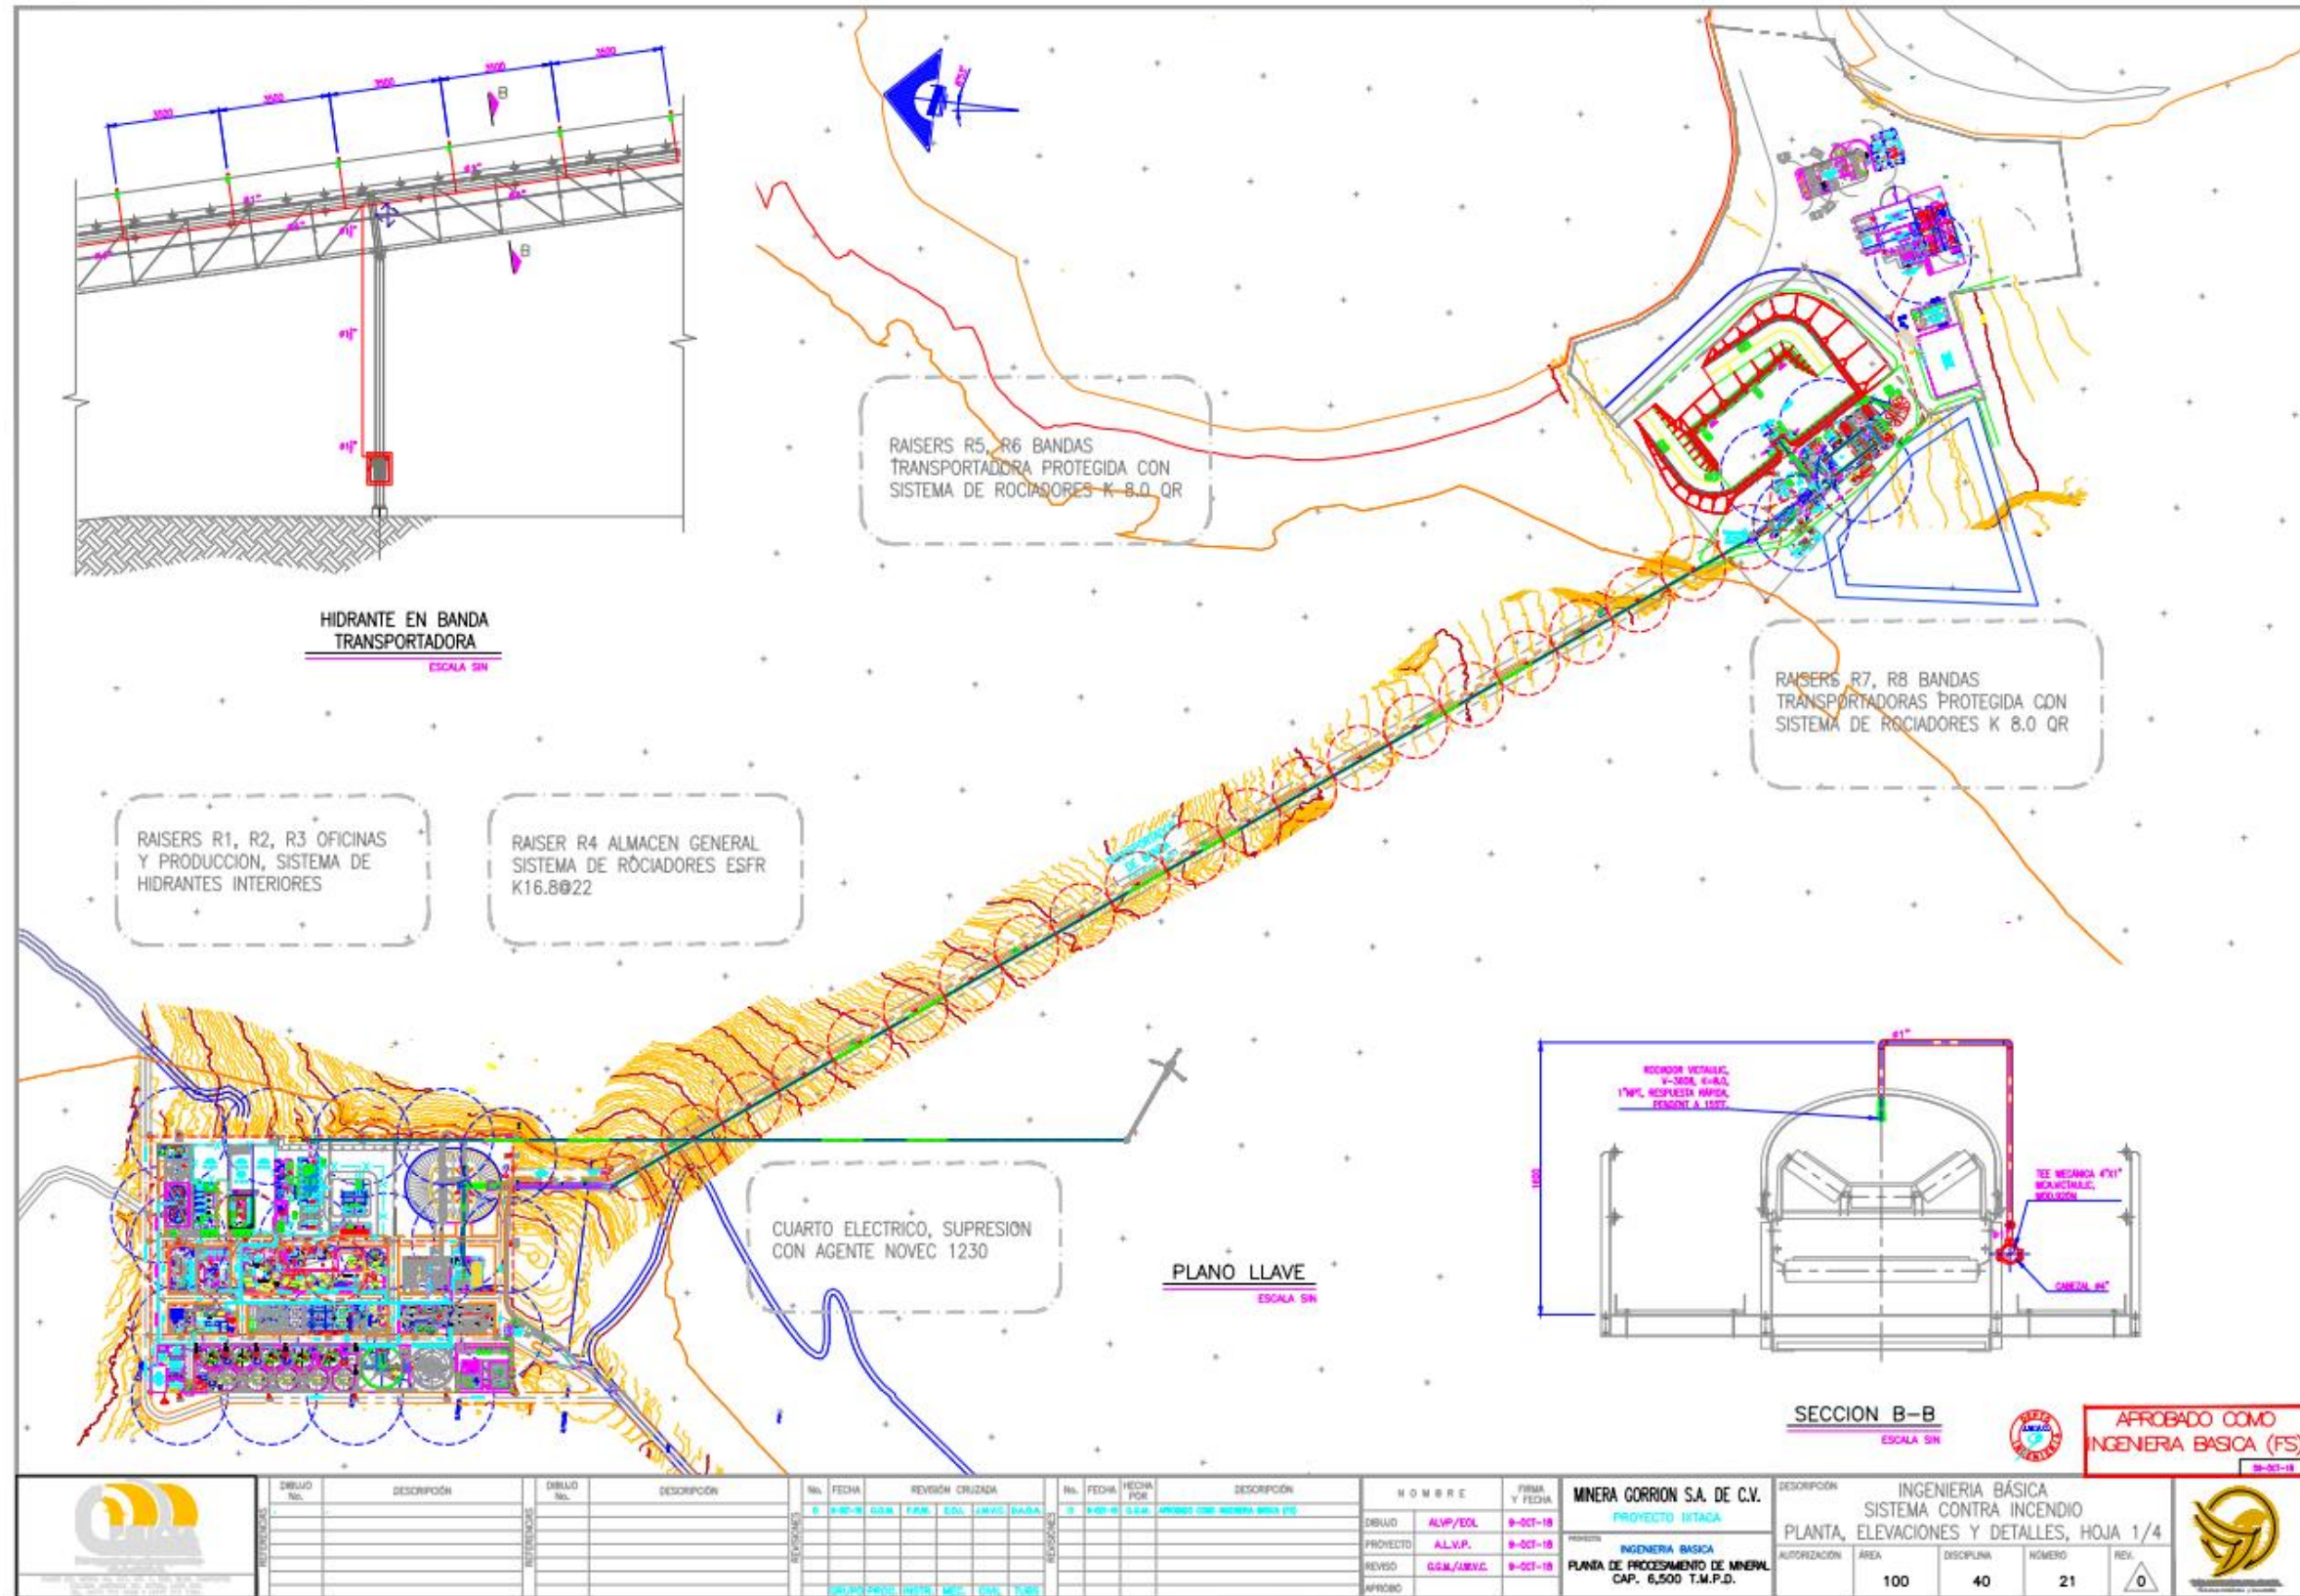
Arreglo General Sistema de Protección Contra Incendios Planta No. 100-40-21 Rev 0
